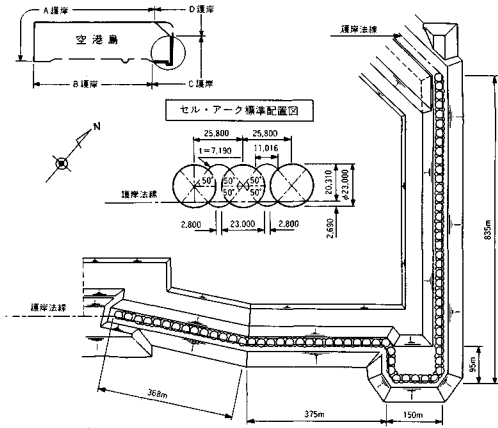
鋼板セル護岸(C護岸)位置図およびセル・アーク配置図
